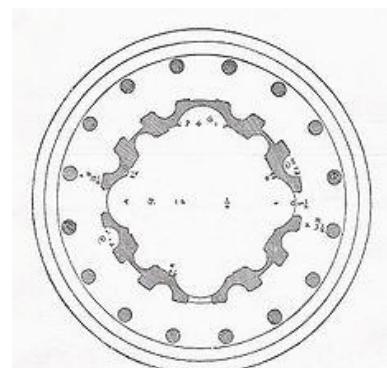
Tempietto de San Pedro in Montório, Roma (Planta)
